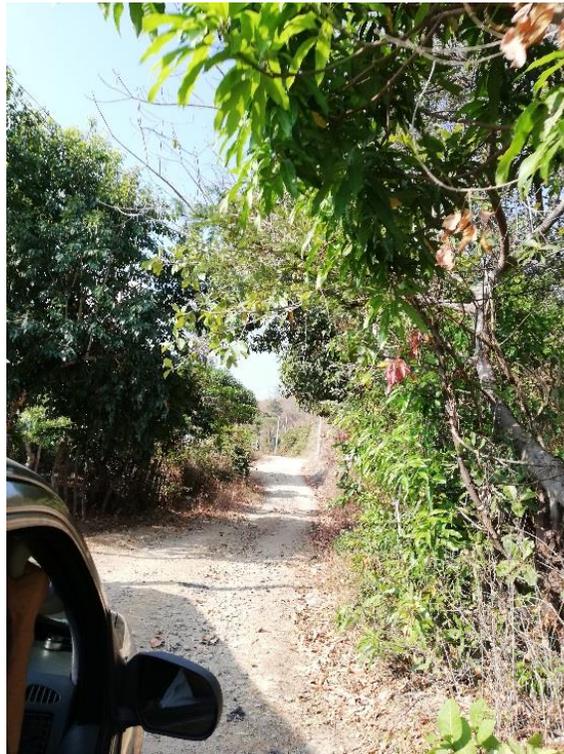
Acceso a Terreno. Fuente: Foto tomada por grupo de trabajo
